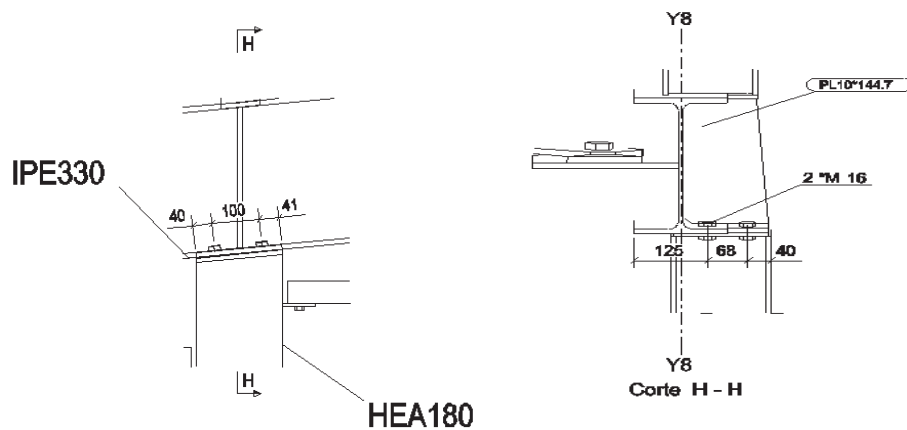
Proposta de alteração da ligação entre os perfis HEA 180 e IPE 330.
